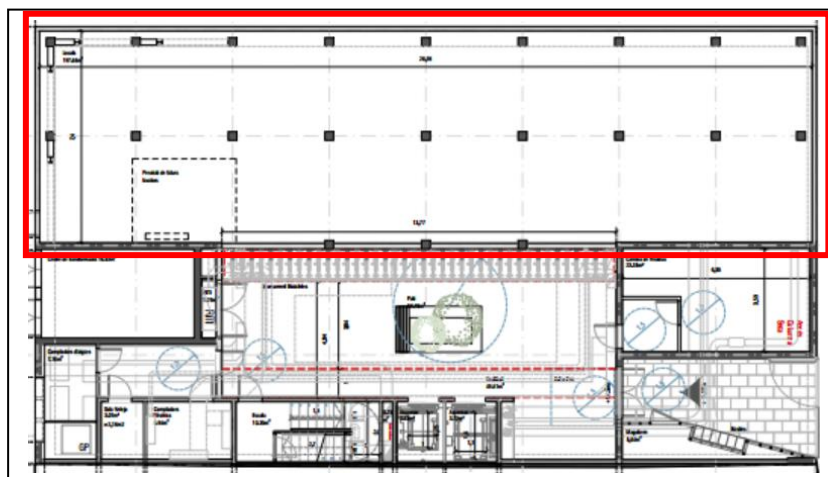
Ubicación en planta baja del recinto emisor del ensayo ACU-24-119841 (22).
